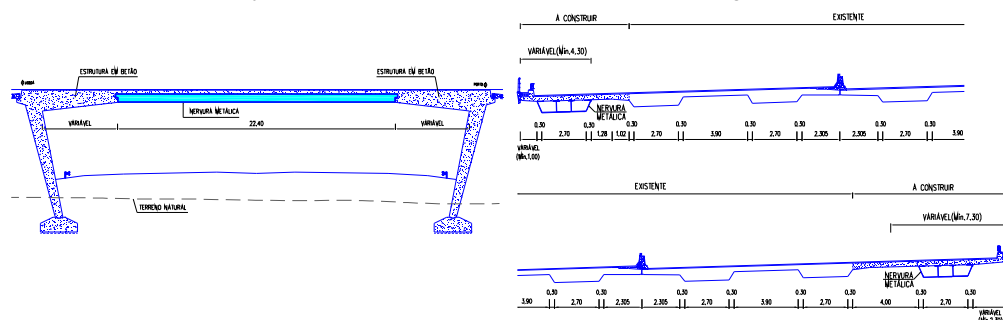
Cortes longitudinal e transversal do novo tabuleiro
